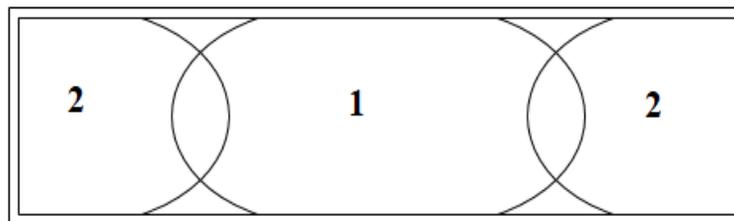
Secuencia de llenado del molde (UNE-EN 14651:2007 + A1:2008)
